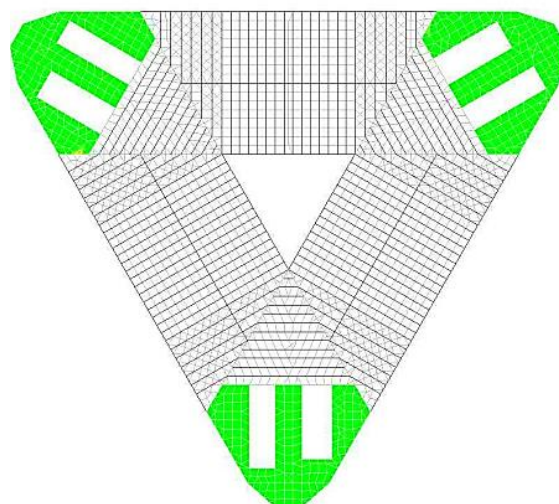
Діаметри нижньої арматури плит перекриття ядер жорсткості по осі X, крок 200 мм
